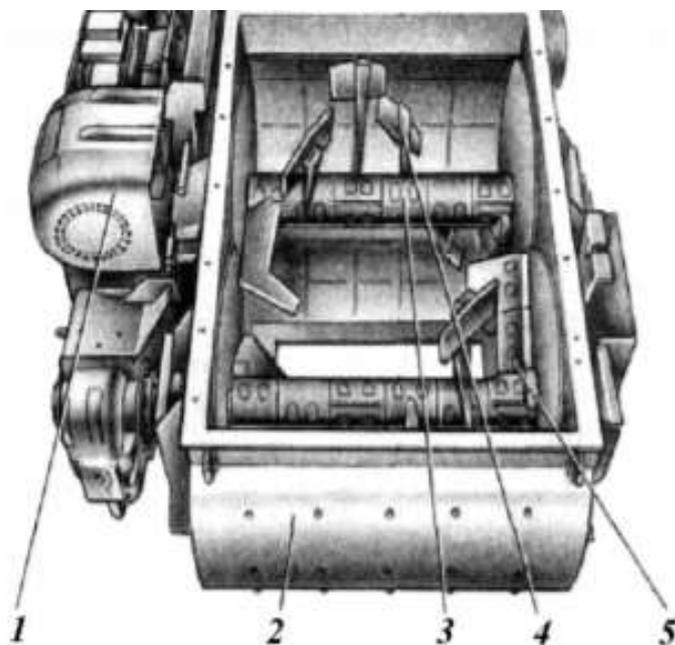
Двухвальный смеситель циклического действия с принудительным перемешиванием: 1 – привод валов; 2 – корпус; 3 – вал; 4 – лопасть; 5 – разгрузочный люк.
